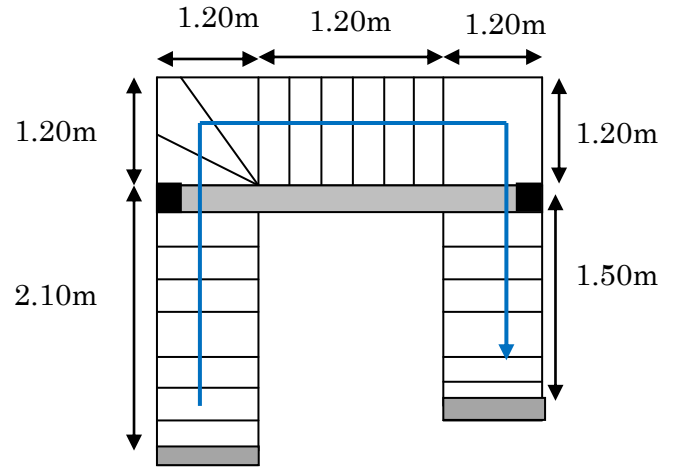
Vue en plan de l'escalier de rez de chaussée
